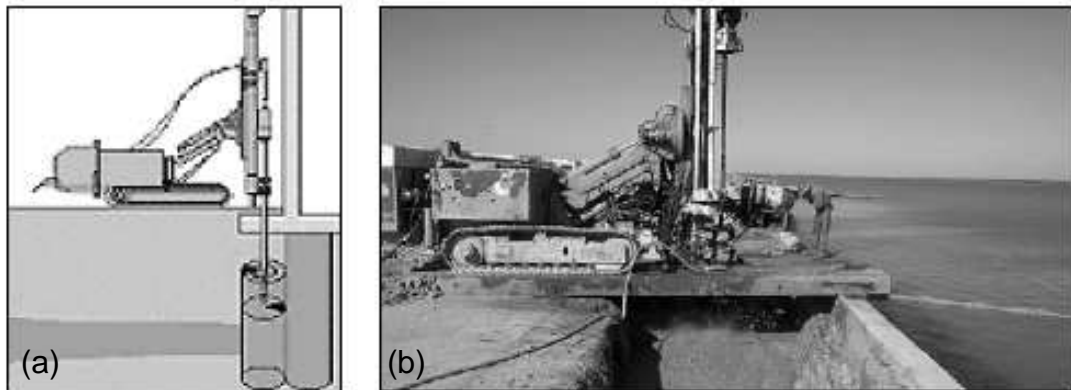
“Jet Grouting” - (a) Croqui da implantação de uma coluna de “Jet Grouting” e (b) Foto do equipamento de instalação – (Fonte: HUSSIN, 2006)
